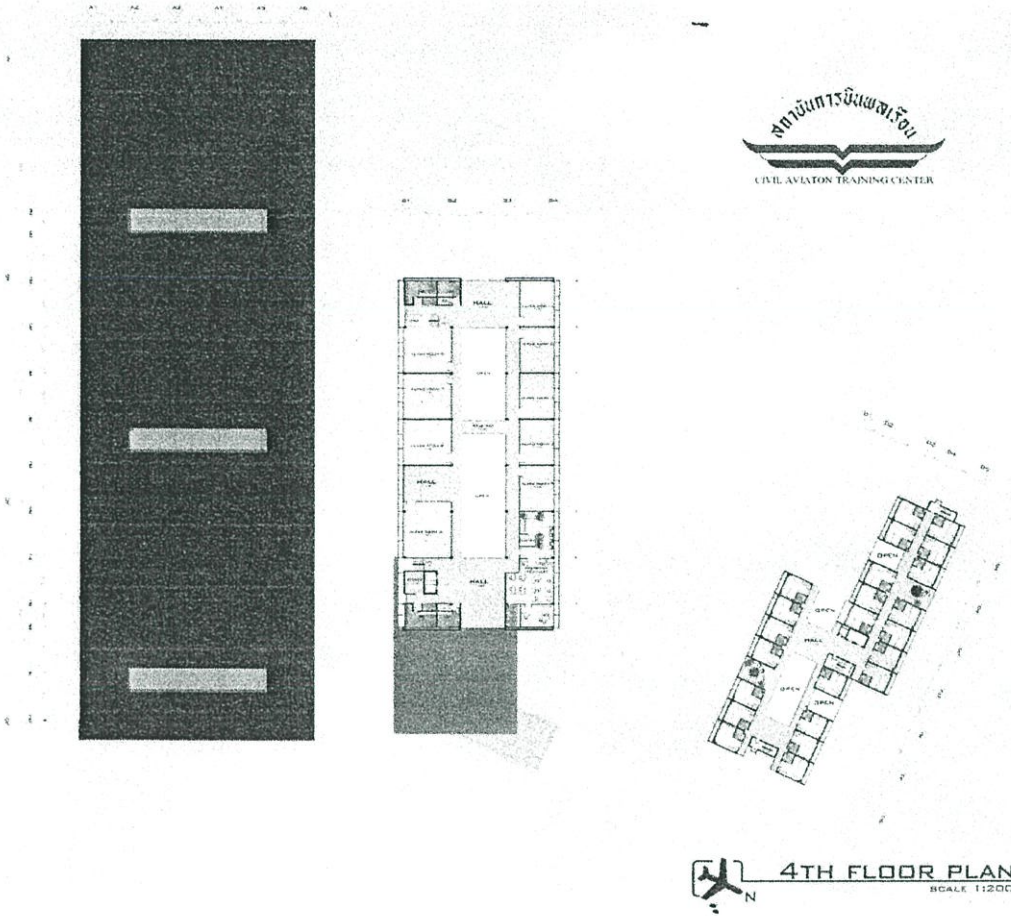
แสดงผังพื้นที่ 1
